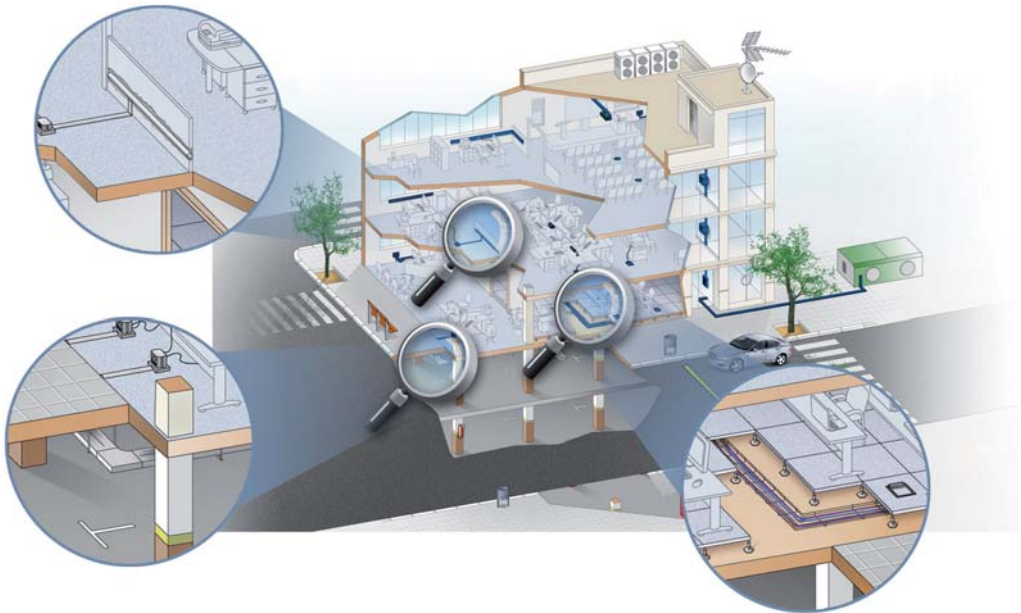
Ejemplo de canalizaciones eléctricas constituidas por el conjunto de conductores más sistemas de conducción de cables en instalación eléctrica terciaria
